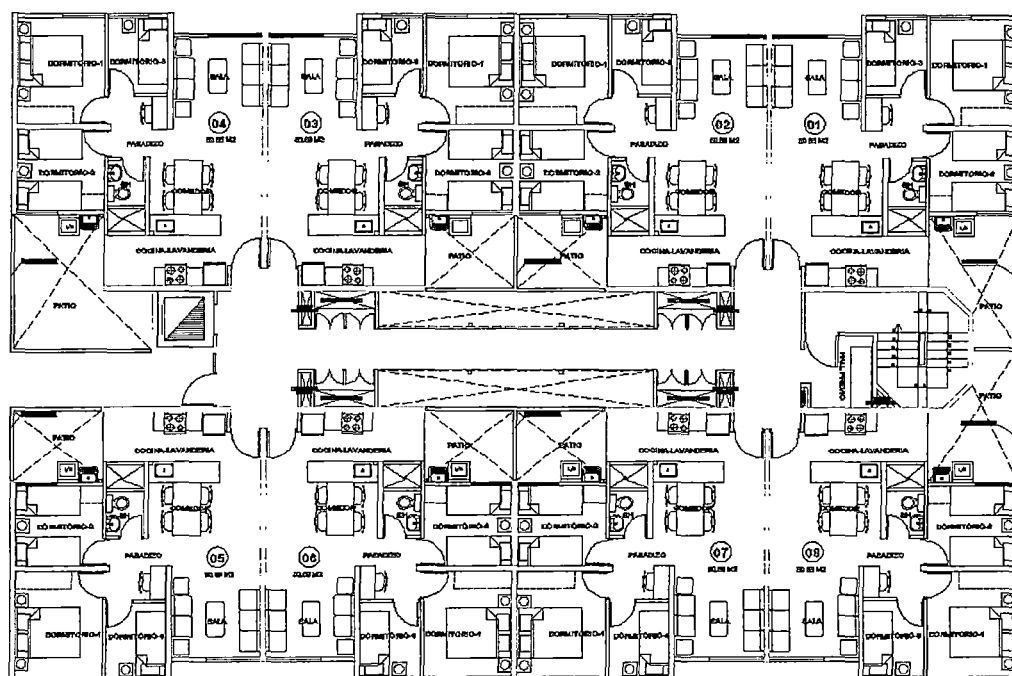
Planta típica Techo Propio con 8 departamentos/piso (De la Piedra Consultores)
